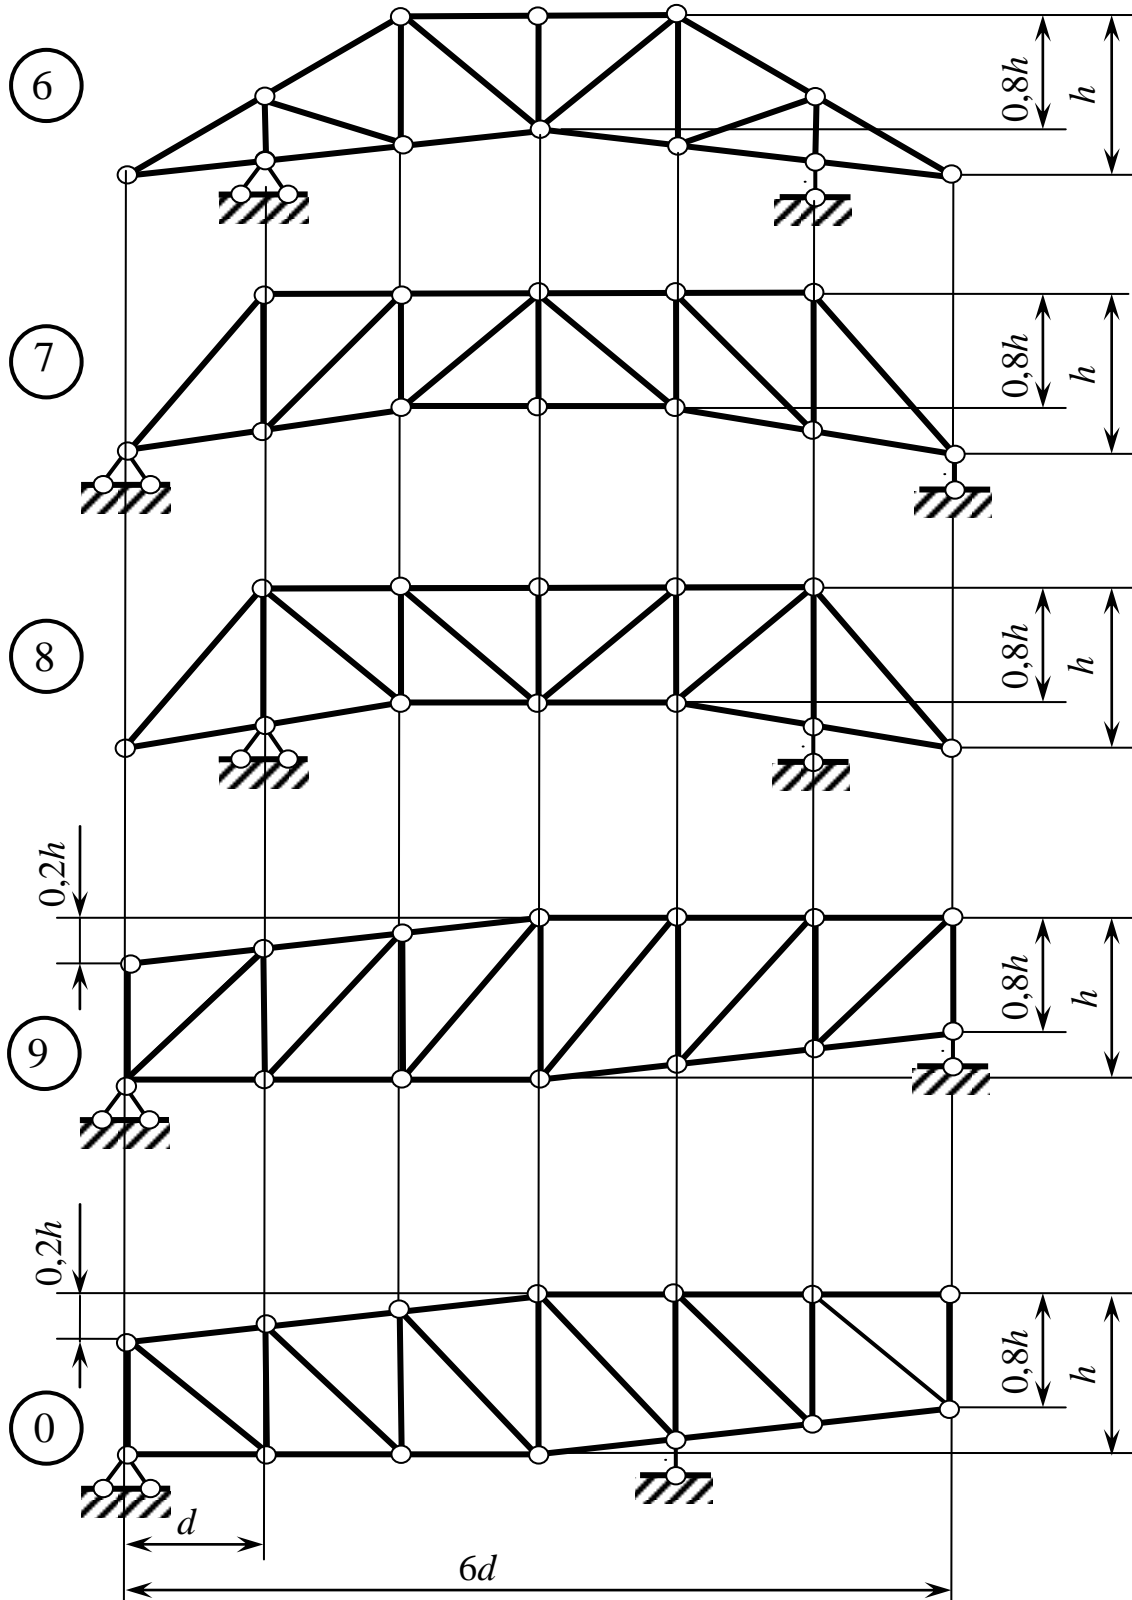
Расчётные схемы ферм к задаче 4 (окончание)
